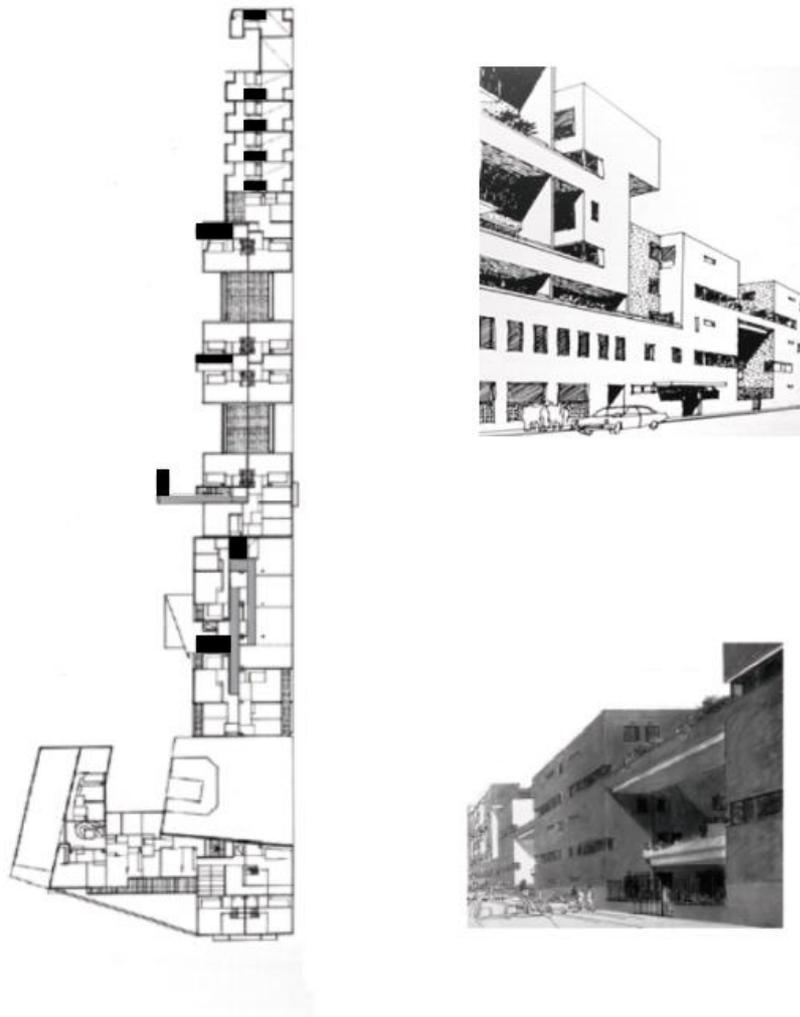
Colombes Planta General y Fachadas urbanas. Fuente: Residencial San Felipe: la calle aérea,
